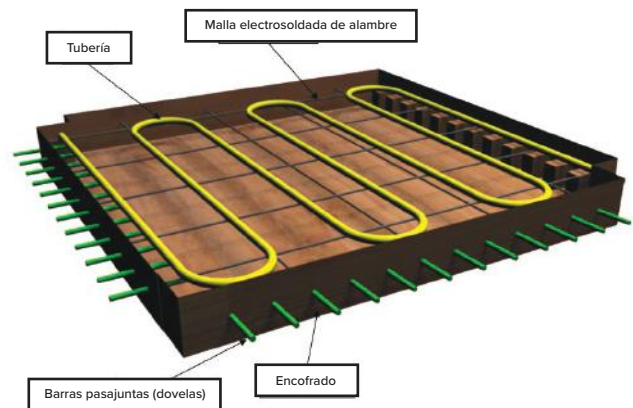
Visualización de la fabricación de una losa calefaccionada hidrónica con pavimento de concreto prefabricado (ilustración cortesía de la ISU)
